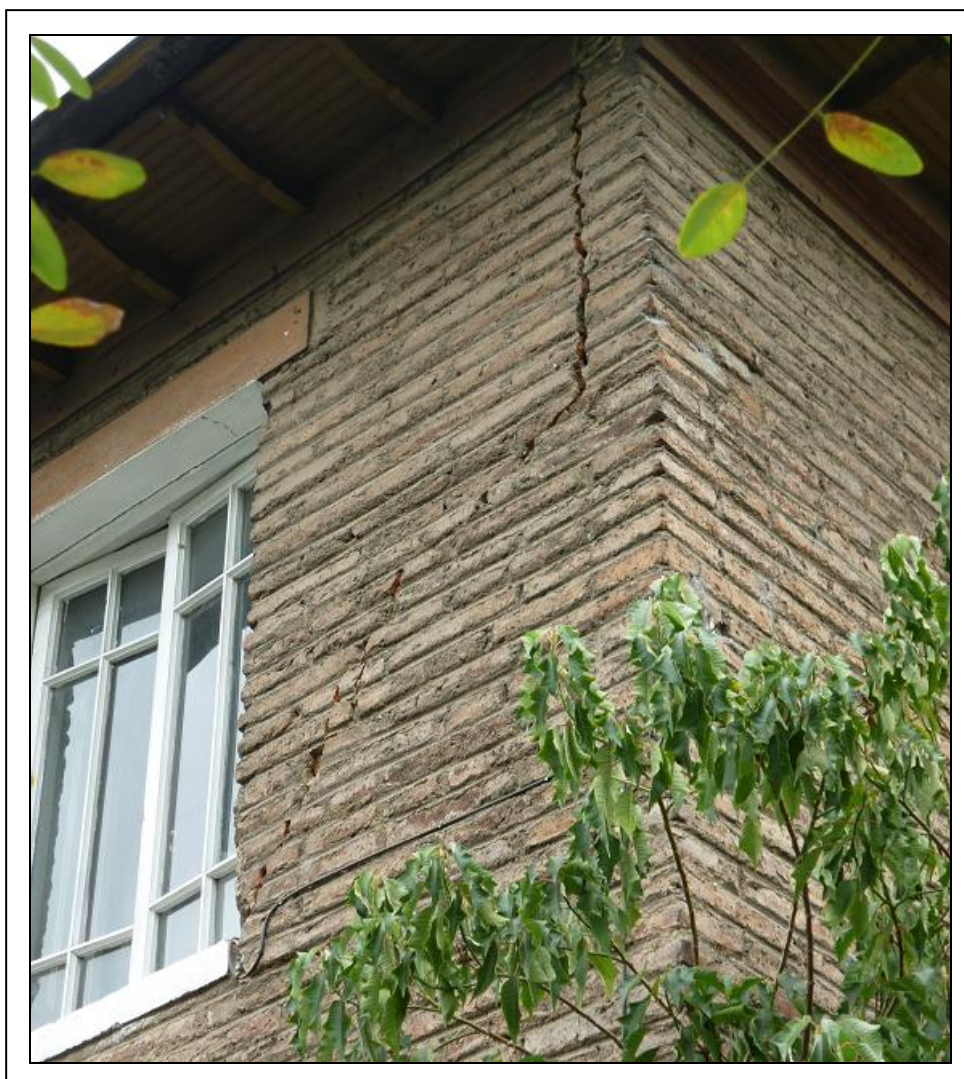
, Inapropiada conexión entre muros y cubierta. Imagen propia
